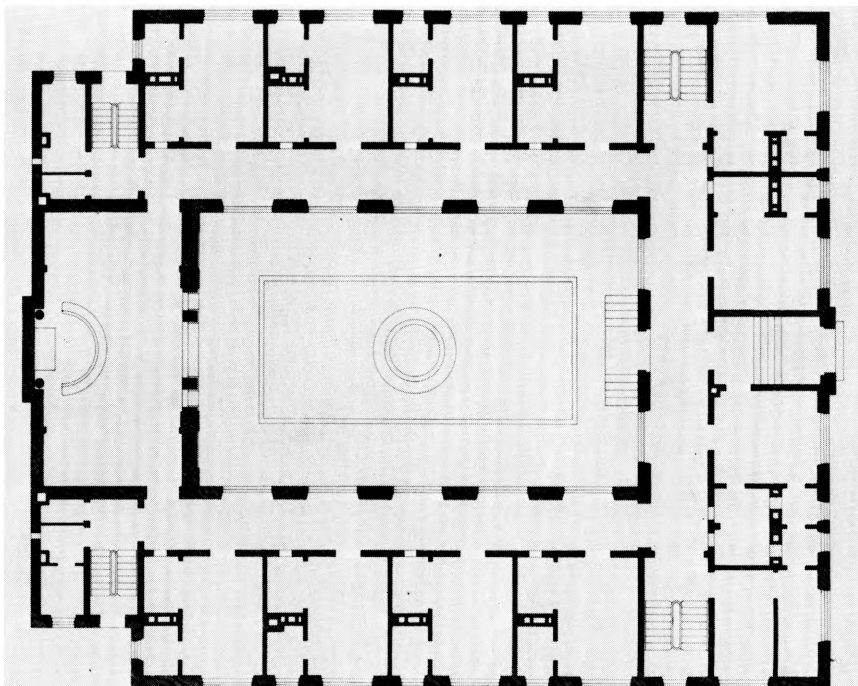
Plan af stiftelsens første etage. 1:300 (s. 166). Tegning af H. B. Storck. Kunstakademiets Bibliotek. – *Plan of the ground floor of the Abel Cathrine Foundation. Drawing by H. B. Storck.
